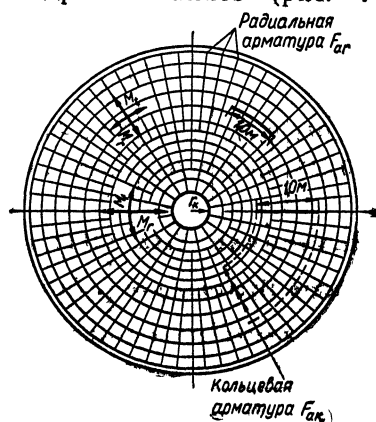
Радиально-кольцевое армирование круглой плиты.
